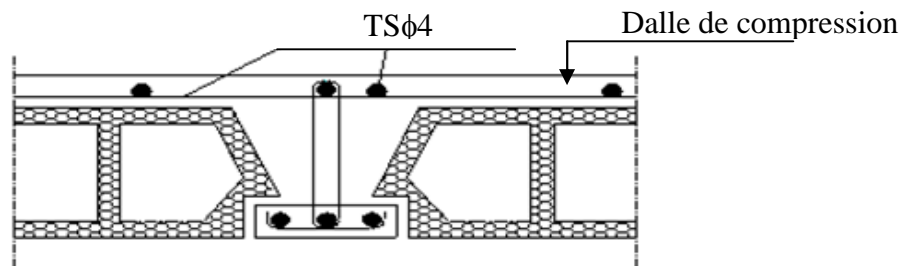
Schéma de ferrailage de la dalle de compression
